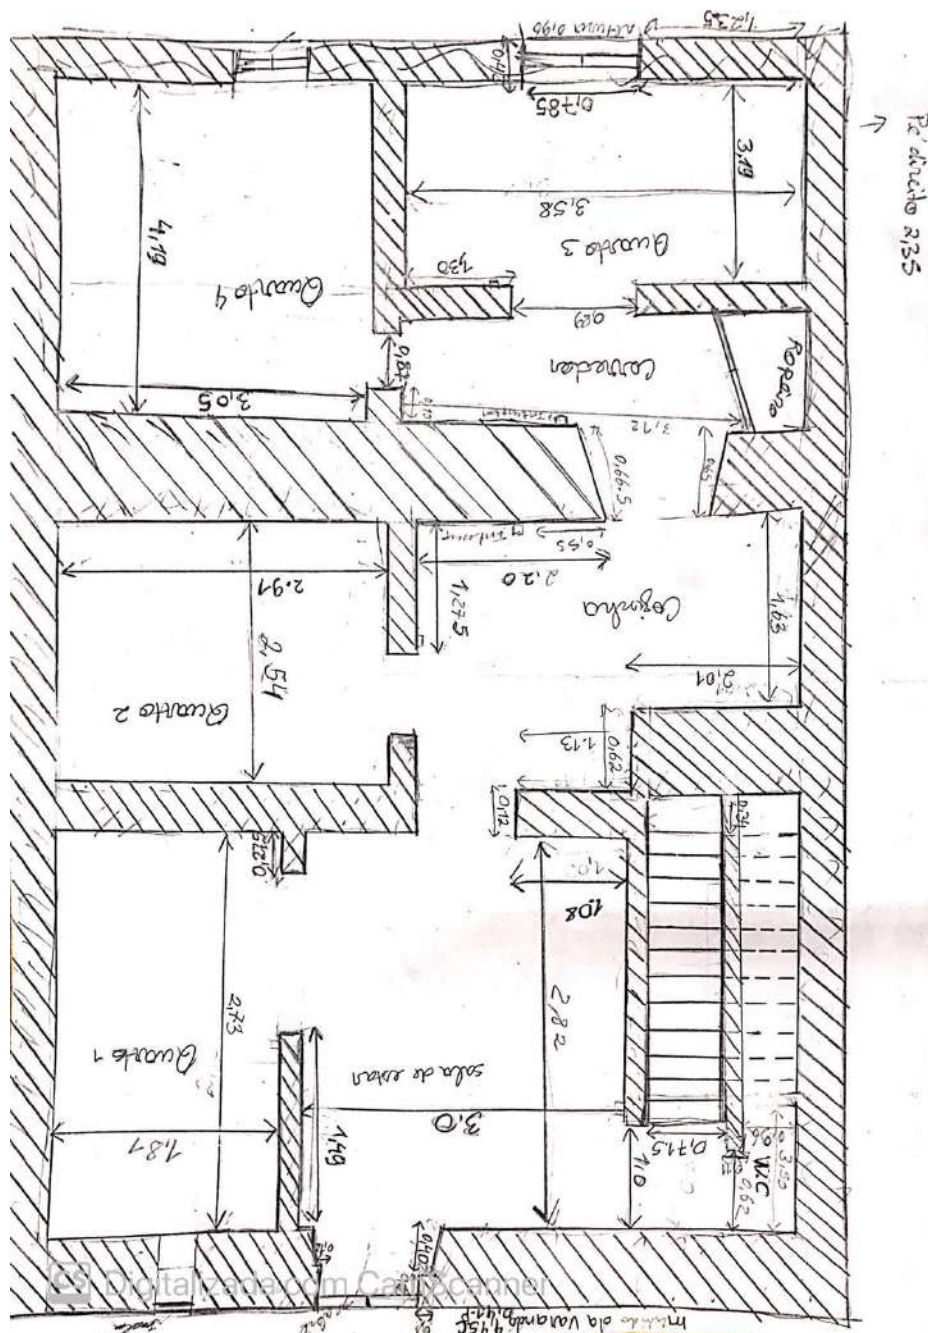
Esboço de planta de levantamento (fonte: Vander Costa, 2025)
